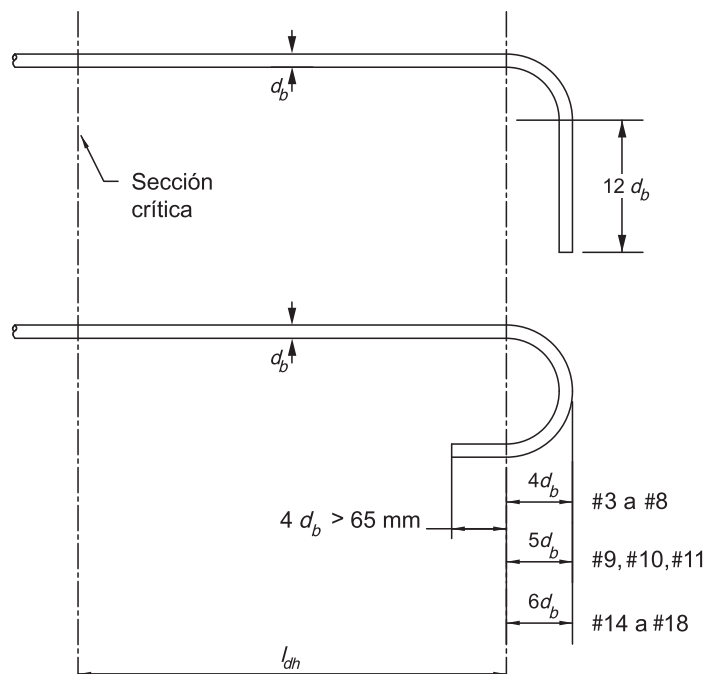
Detalle de longitud de anclaje con gancho estándar.
